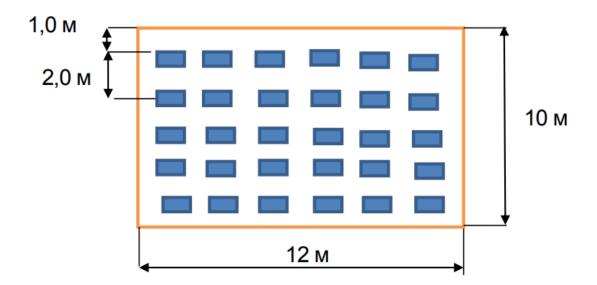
План помещения и размещения светильников с люминесцентными лампами (масштаб 1:200).
